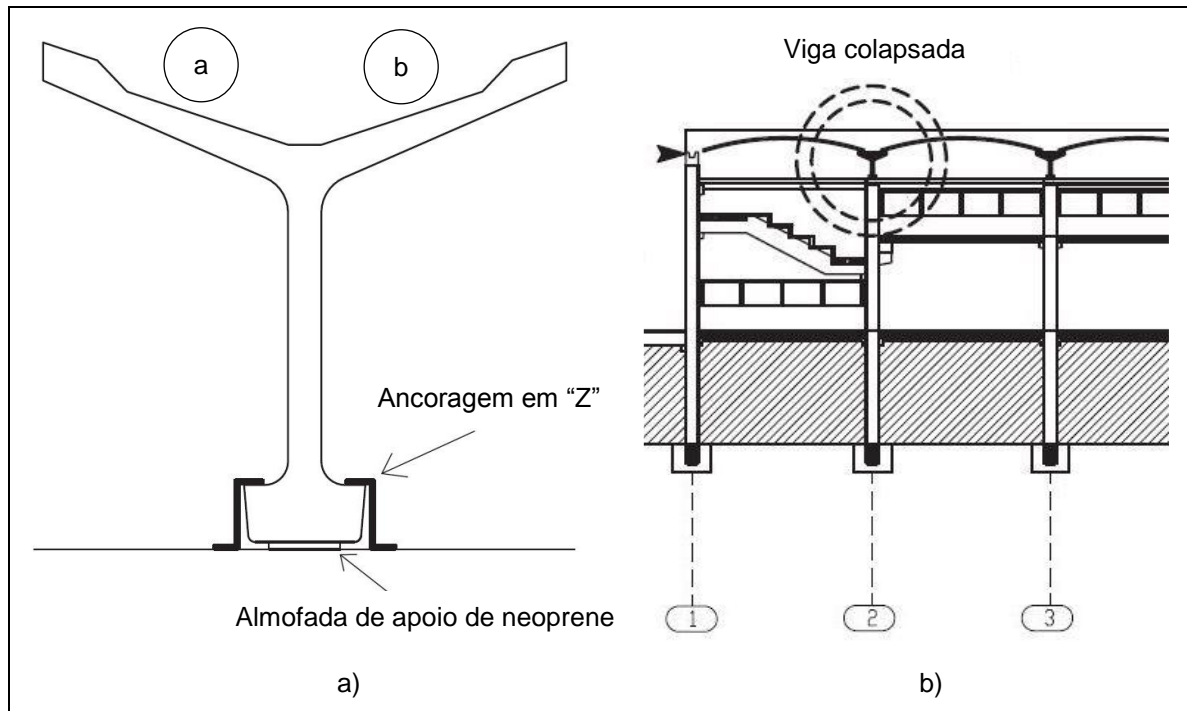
a) Seção transversal da viga analisada por Bairán e Cladera (2014); b) Corte indicando a posição da viga colapsada
